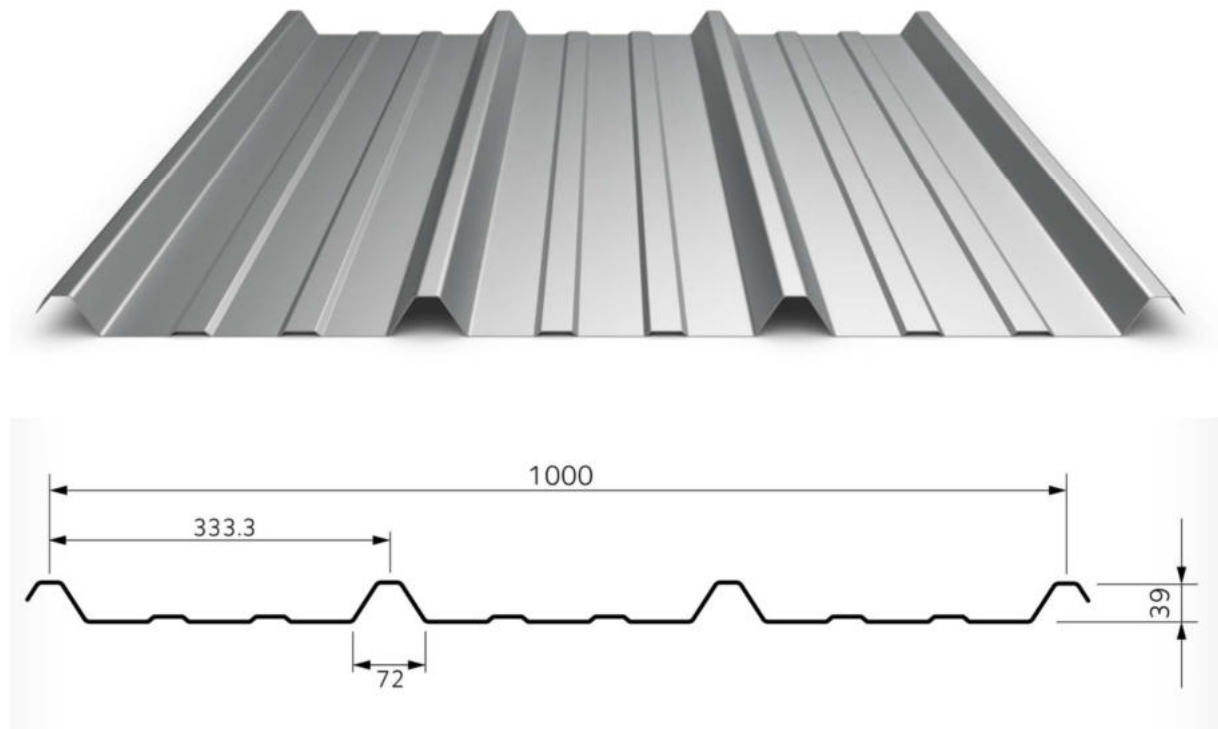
Fassadenverkleidung Trapezblech (unisoliert)
